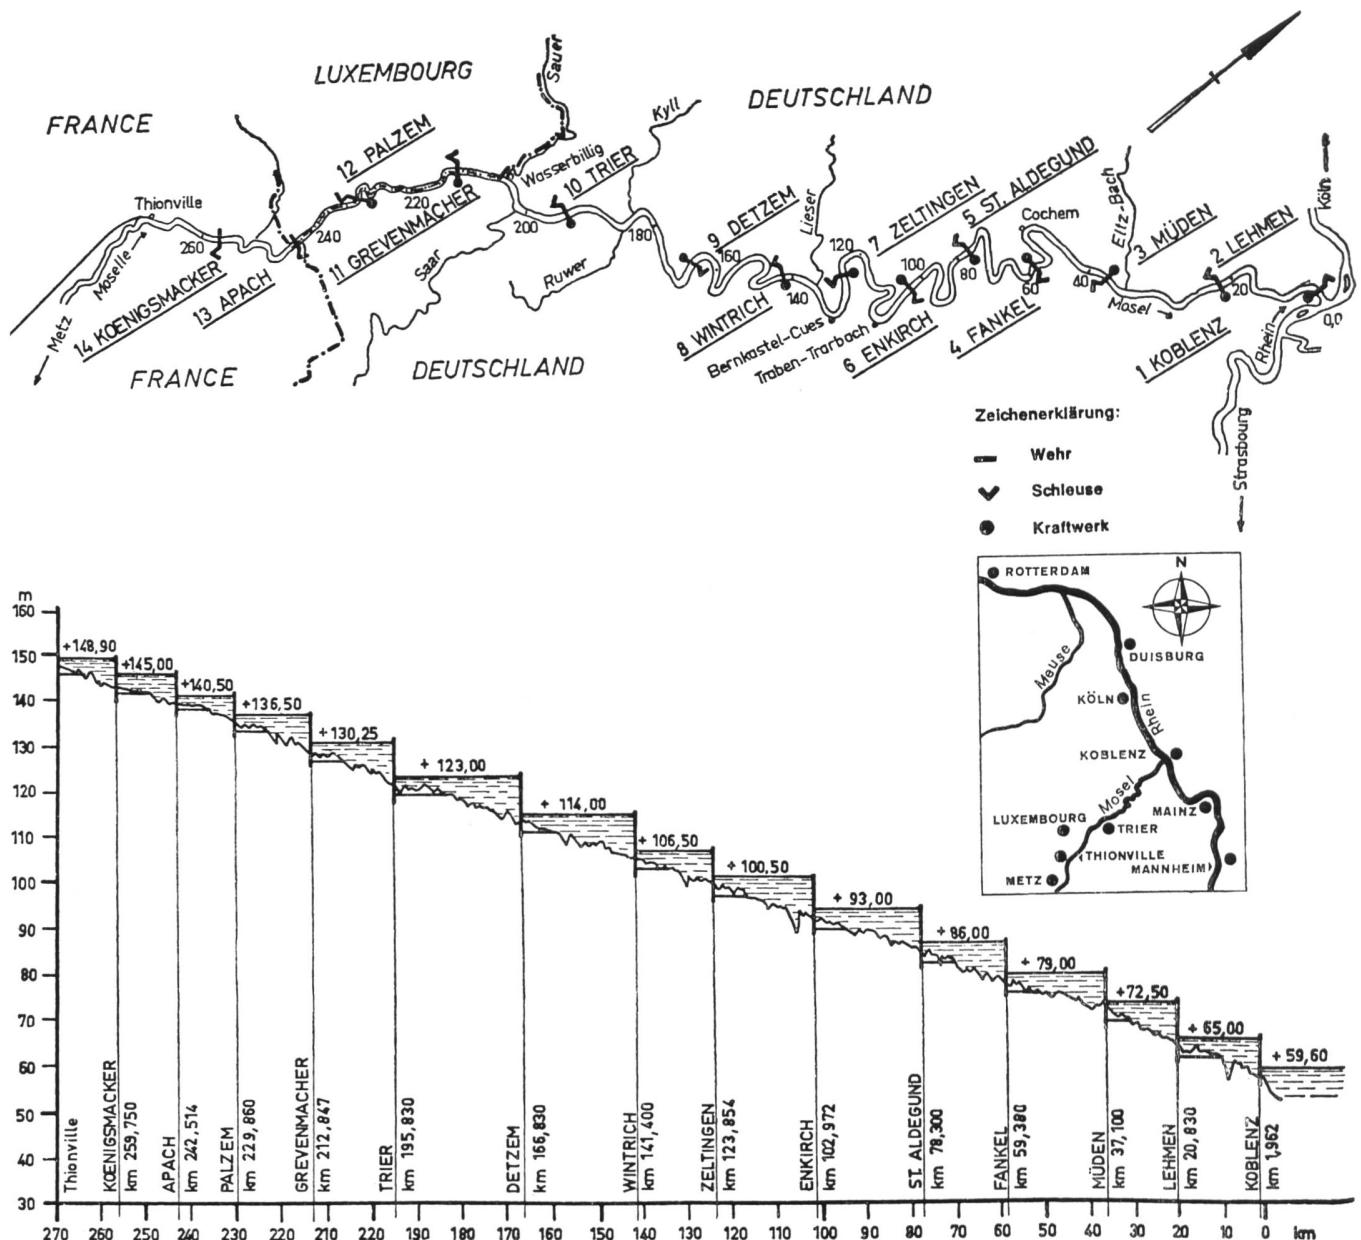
Lageplan und schematisches Längenprofil der Stauhaltungen und Kraftwerkstufen an der Mosel.
